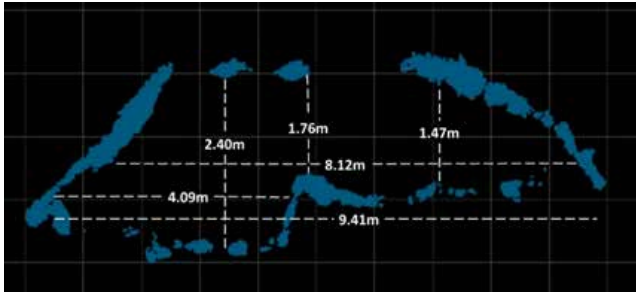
Área del perfil transversal No.1 del segmento de TDD escaneado.
